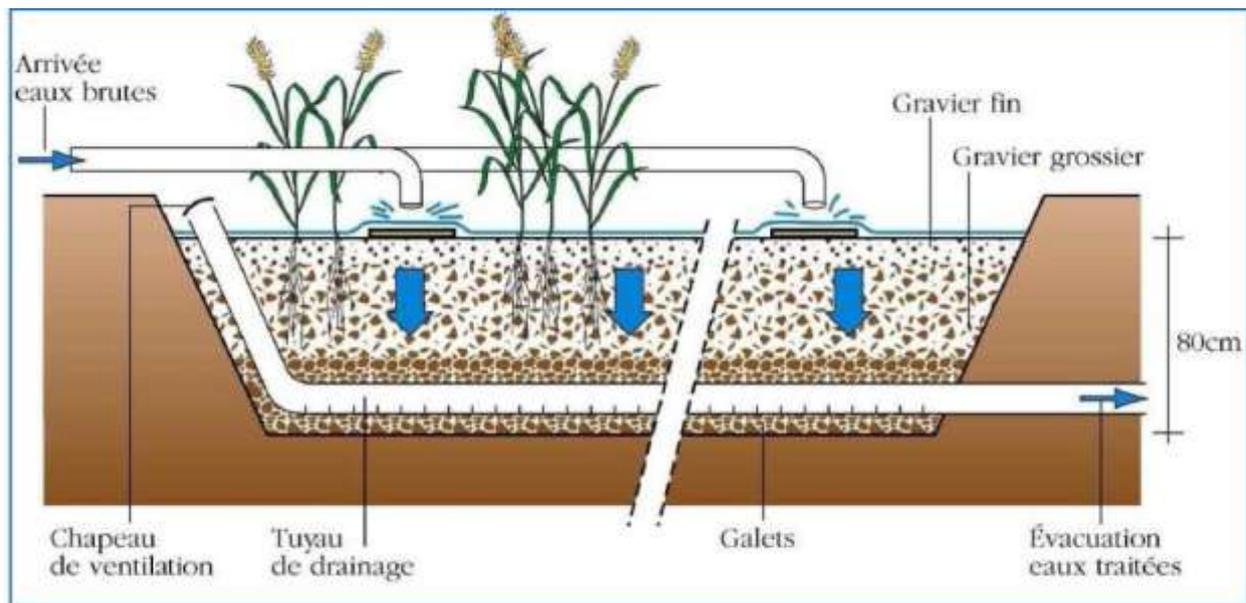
Coupe transversale d'un filtre planté à écoulement vertical (source CEMAGREF)
